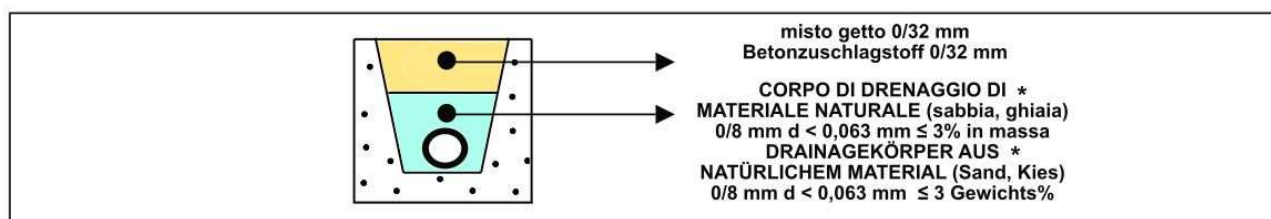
Auffüllungen und Drainagen (A Straßenbauwerke und B Gebäude):
